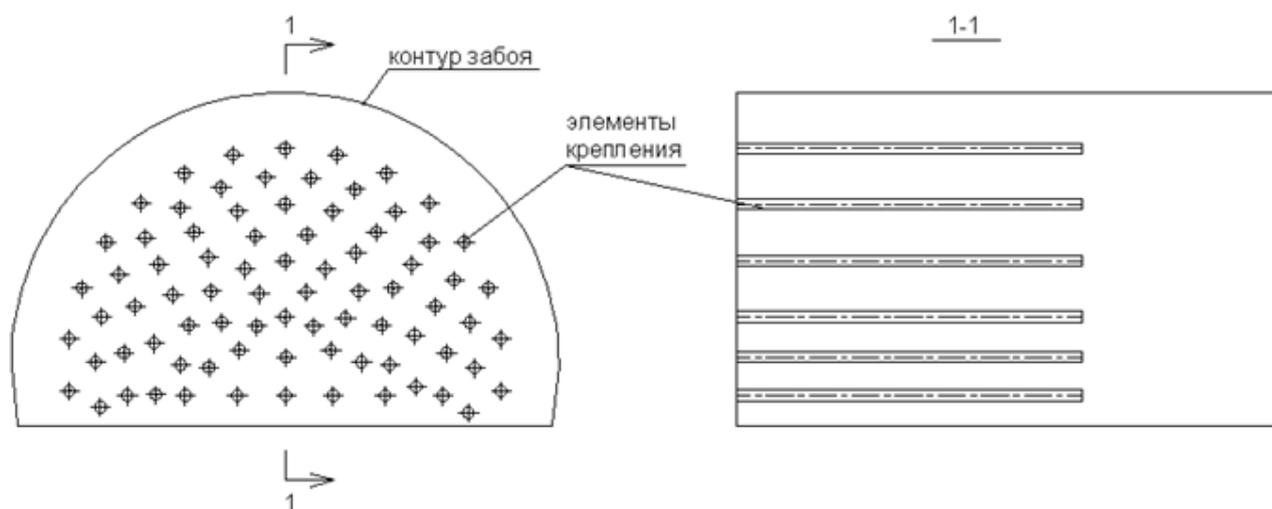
Опережающее крепление забоя по трассе проходки при помощи армирующих элементов из АНК-С
